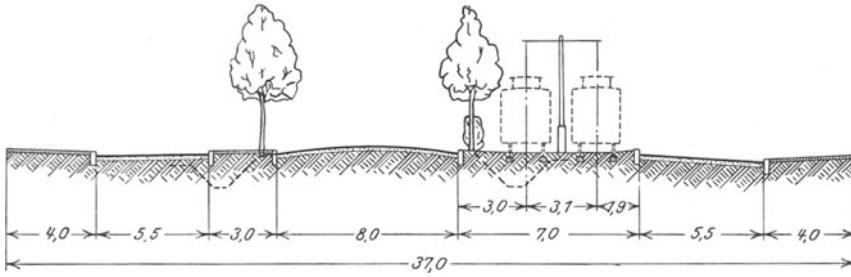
Umbau einer Landstraße in eine städtische Ausfallstraße.
